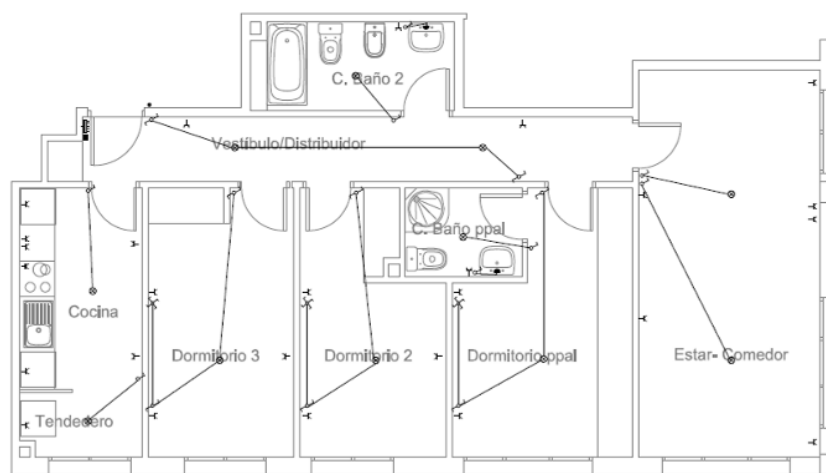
Planta de vivienda tipo considerada (Fuente: www.presupuesta.com)
